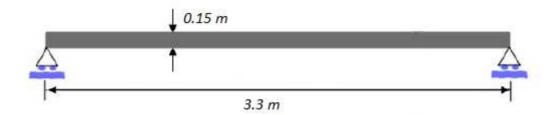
Assimilation de la paillasse à une poutre horizontale simplement appuyée.
